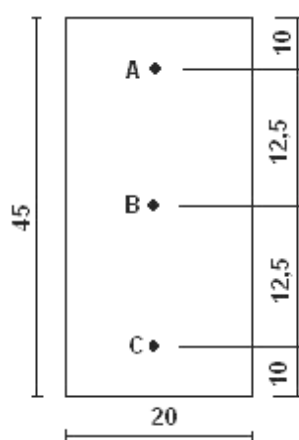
Dimensões da seção transversal da viga armada VR 20 x 45 (em cm)
